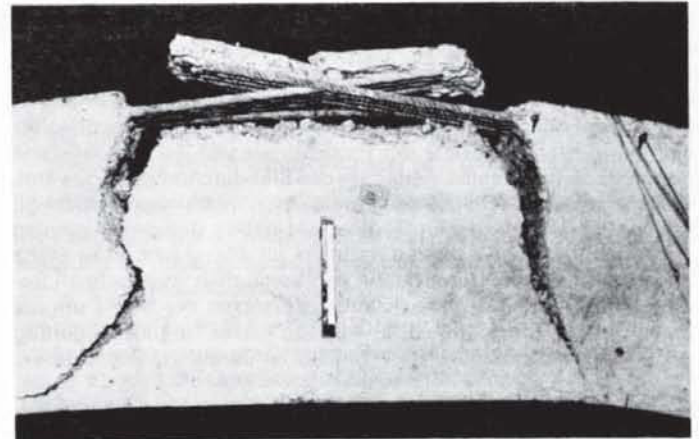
Bruchbild eines Übergreifungsstoßes bei innenliegender Querbewehrung (nach [ 13])
